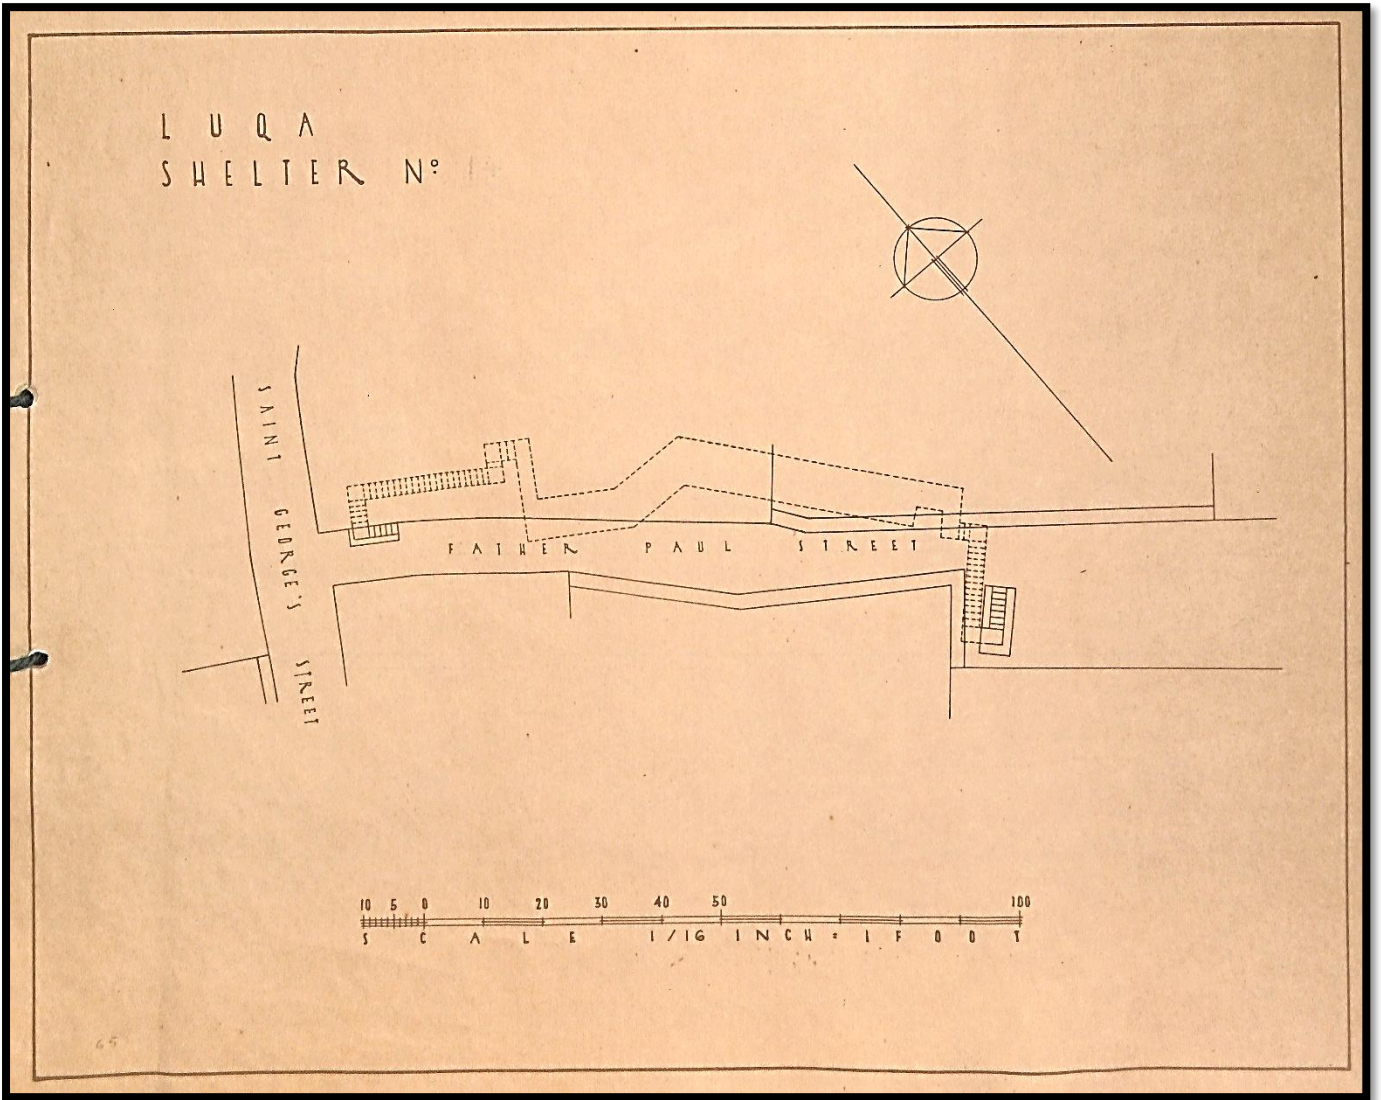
Planta do Abrigo nº14 "Father Paul Street – Saint George's Street"
